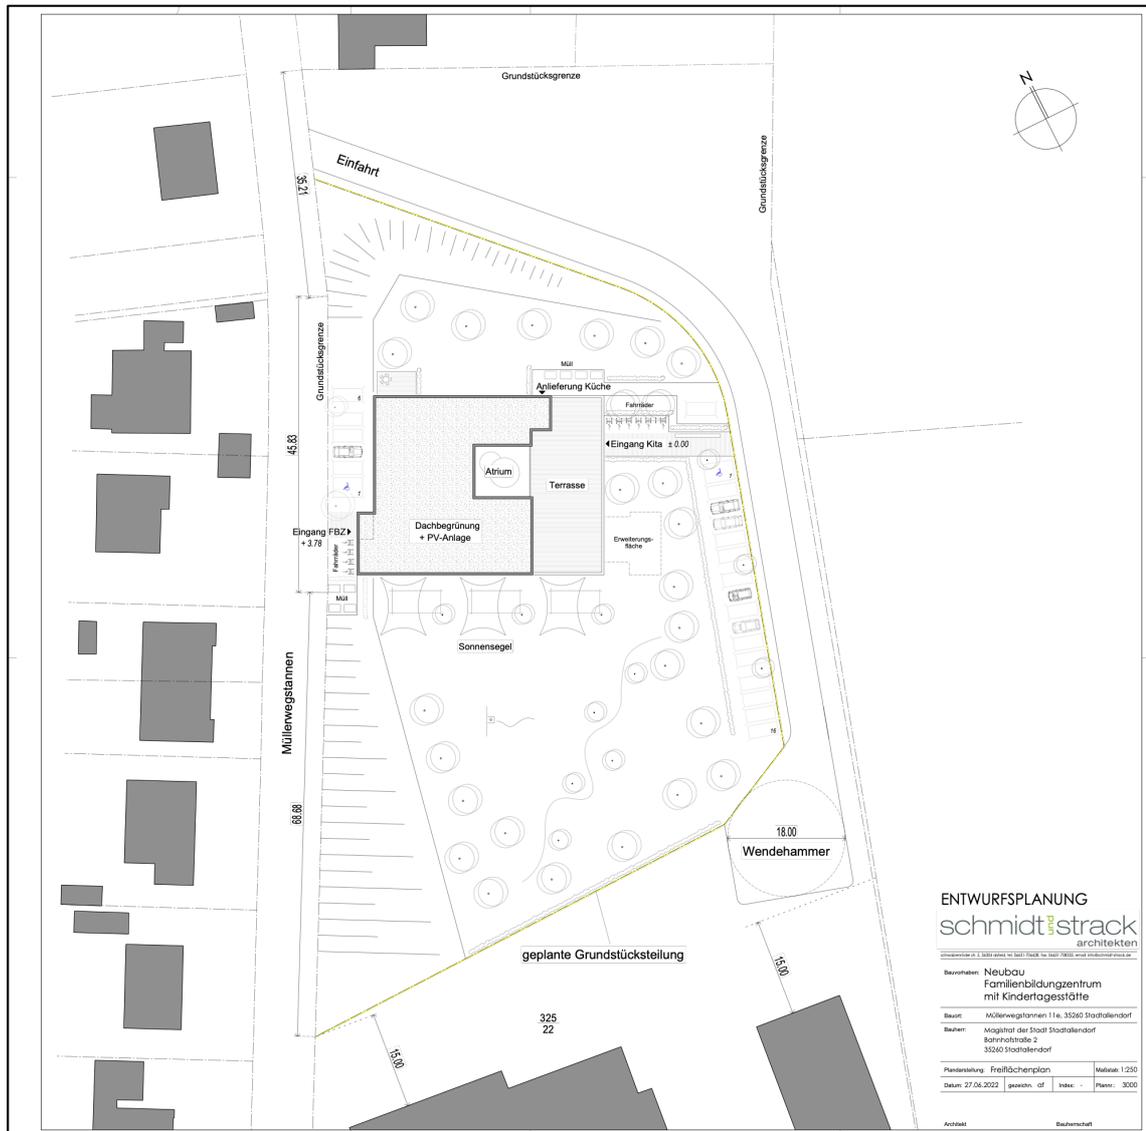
Freiflächenplan (Schmidt & Strack Architekten, Alsfeld, Stand 06/2022)
